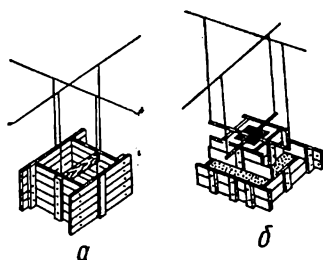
Схема установки опалубки под отдельные фундаменты:
